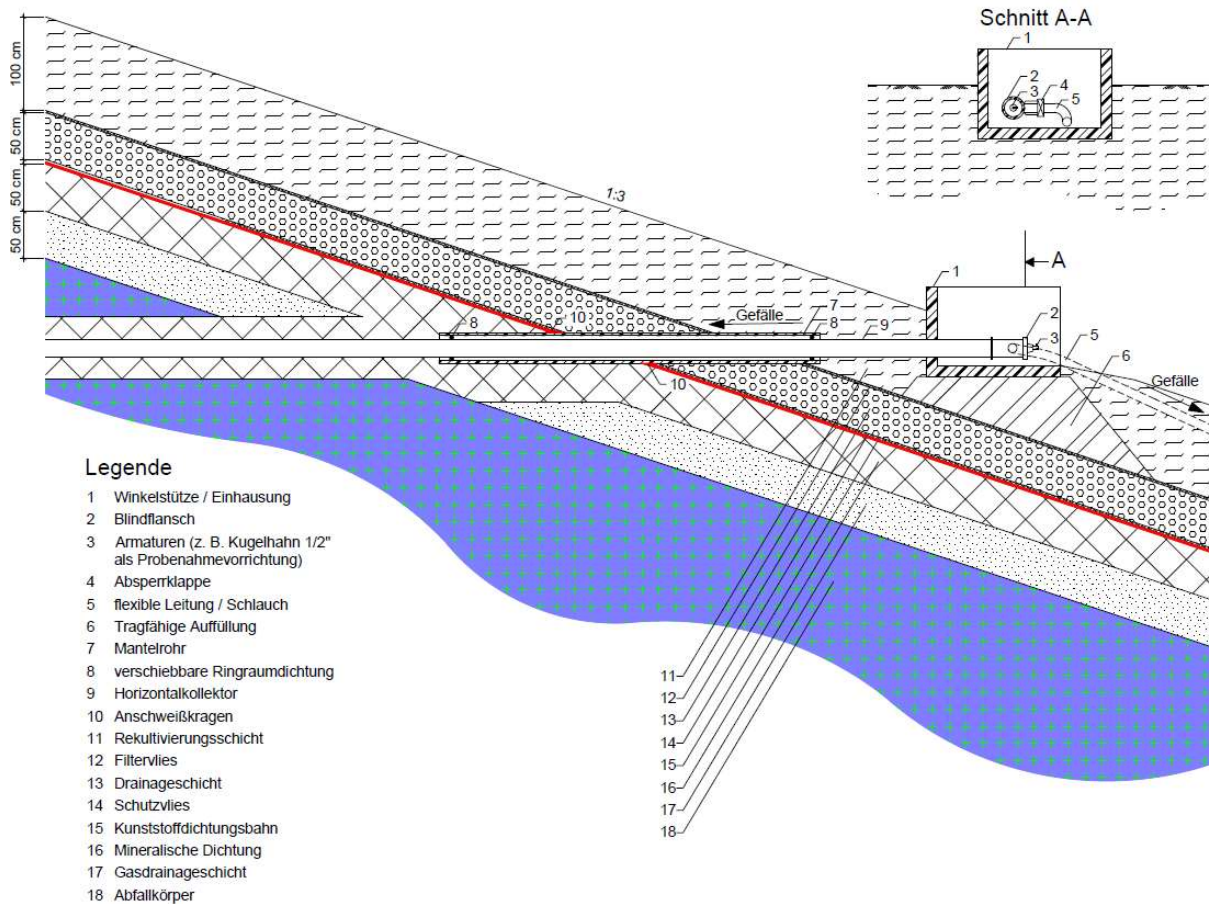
Randbereich einer horizontale Gasdränage, Durchdringung der Oberflächenabdichtung
